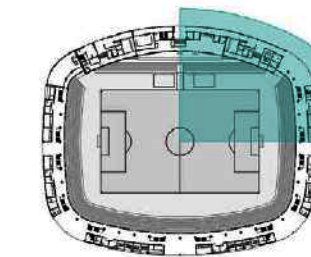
Ampliaciones planta baja Fuente: Elaboración propia
